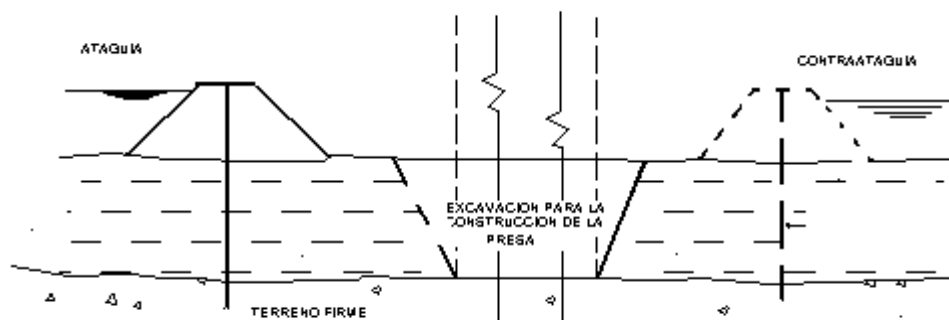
Perfil longitudinal que muestra impermeabilización.
